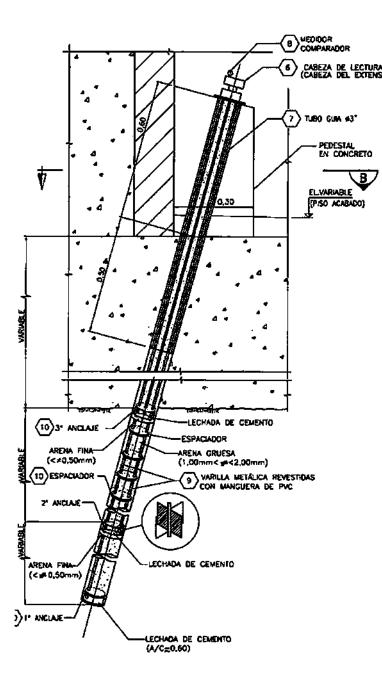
IV.3.2 Trabajos de colocación del extensómetro.
